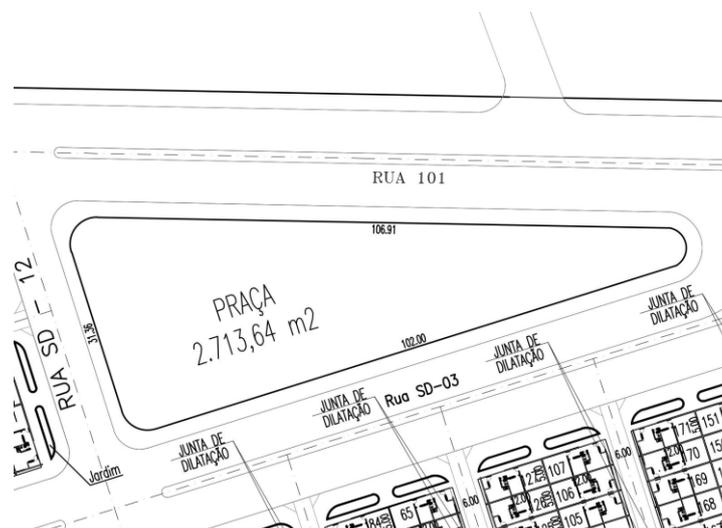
Trecho da planta de implantação do CHIS Rosalina, mostrando praça sem uso definido.
